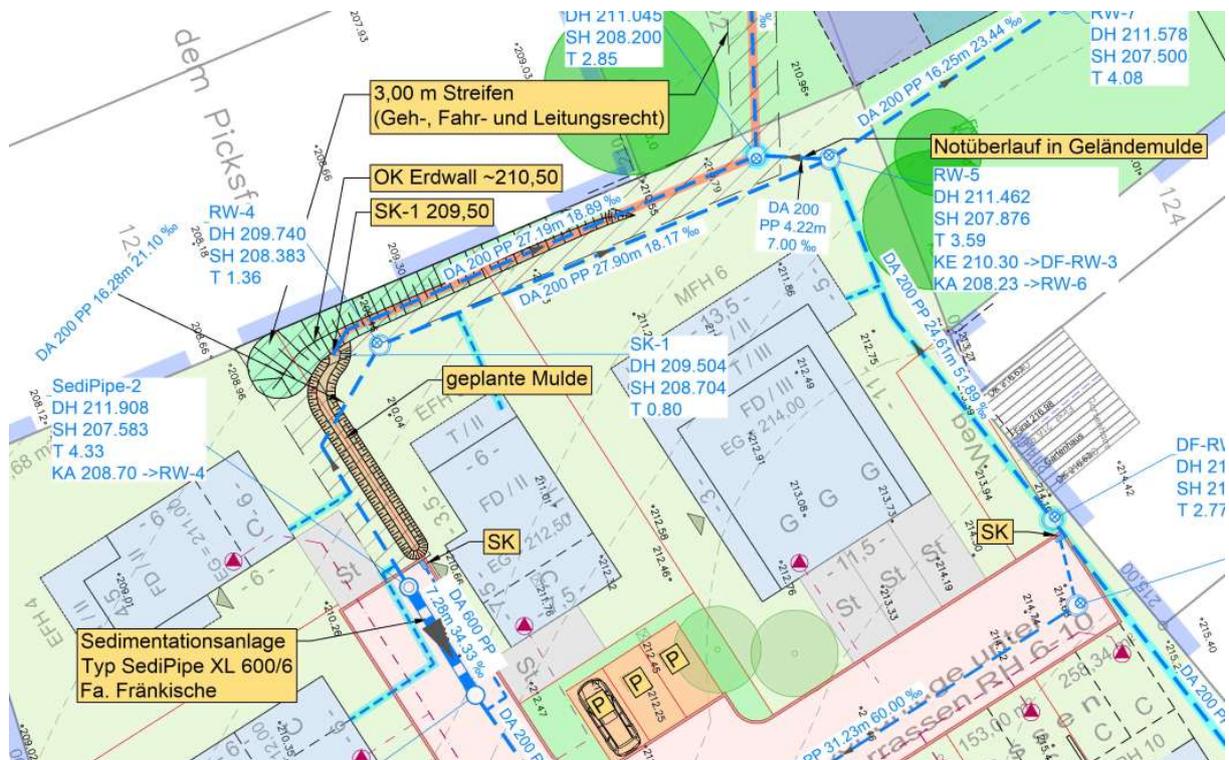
Fachplanung zur Entwässerung, Planausschnitt (Quelle: Ingenieurbüro Brenner GmbH)
